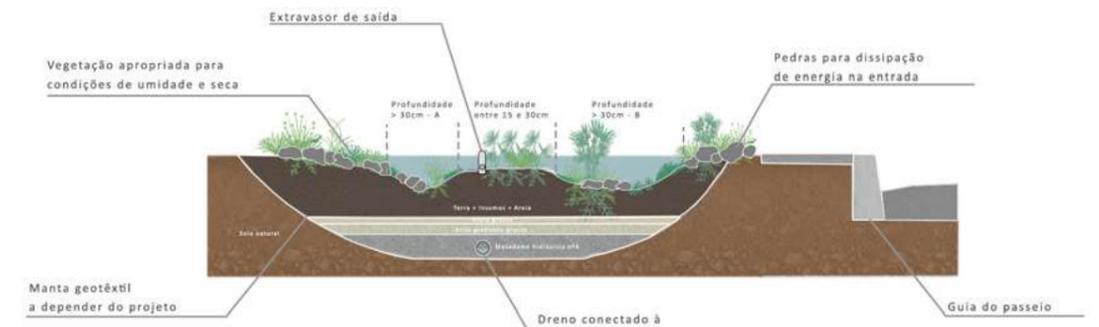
Canteiro pluvial sem paredes laterais e sem laje de fundo, com tubulação/duto de conexão com drenagem convencional existente (Fonte: Guajava, 2023)
